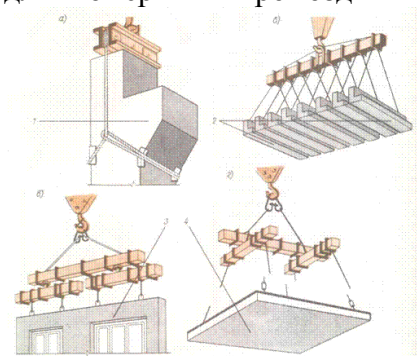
Балочные траверсы а — с двумя стропами; б — с восемью стропами; в, г — с подвесными коромыслами; 1 — колонна; 2 — перемычки; 3 — стеновая панель; 4 — панель перекрытия
